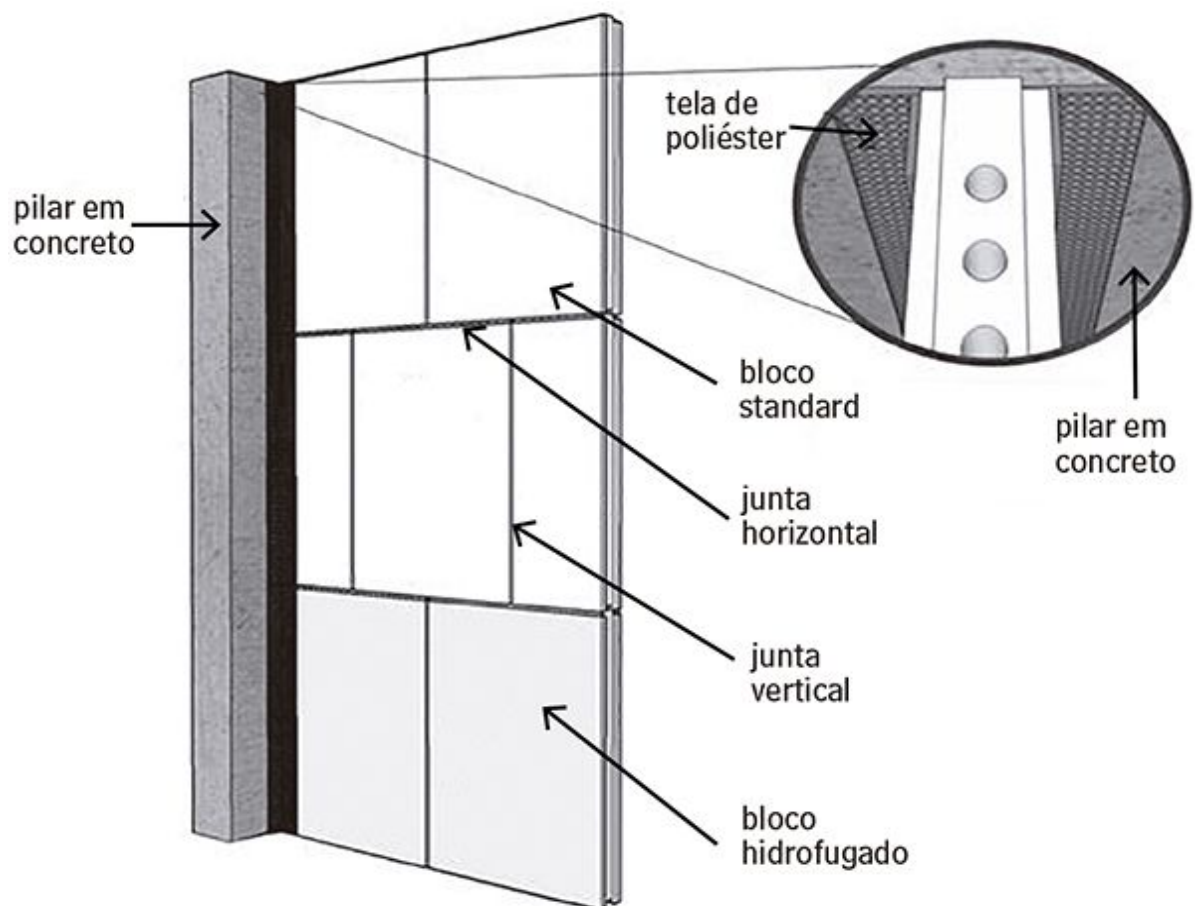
Detalhe do encontro entre a vedação em bloco de gesso e pilar
